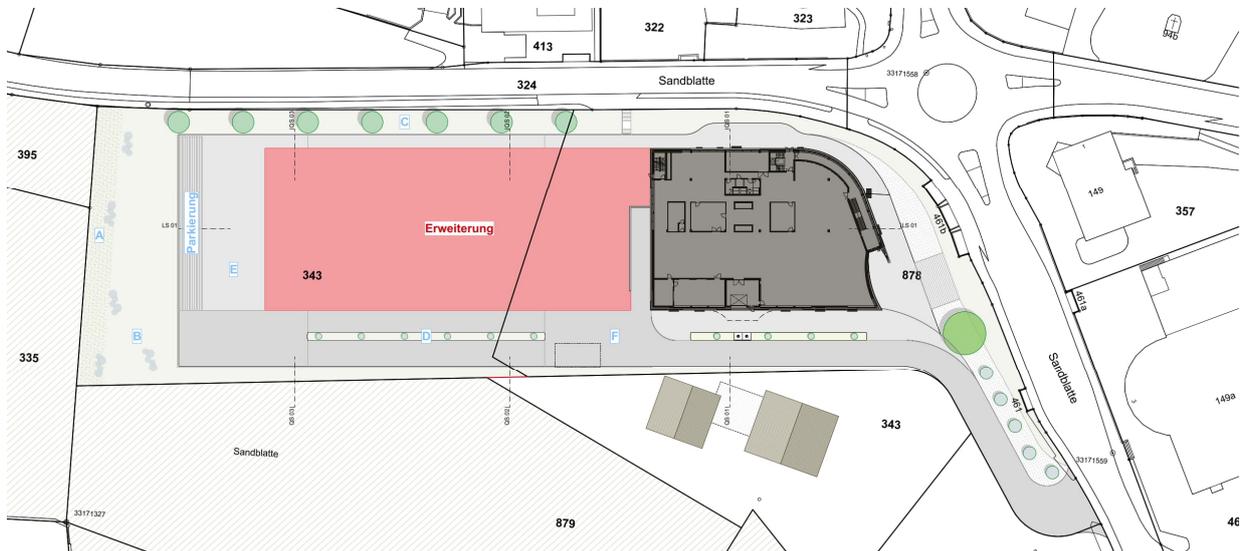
Situationsplan Erweiterungsbau und Umgebungskonzept (BF architekten)
